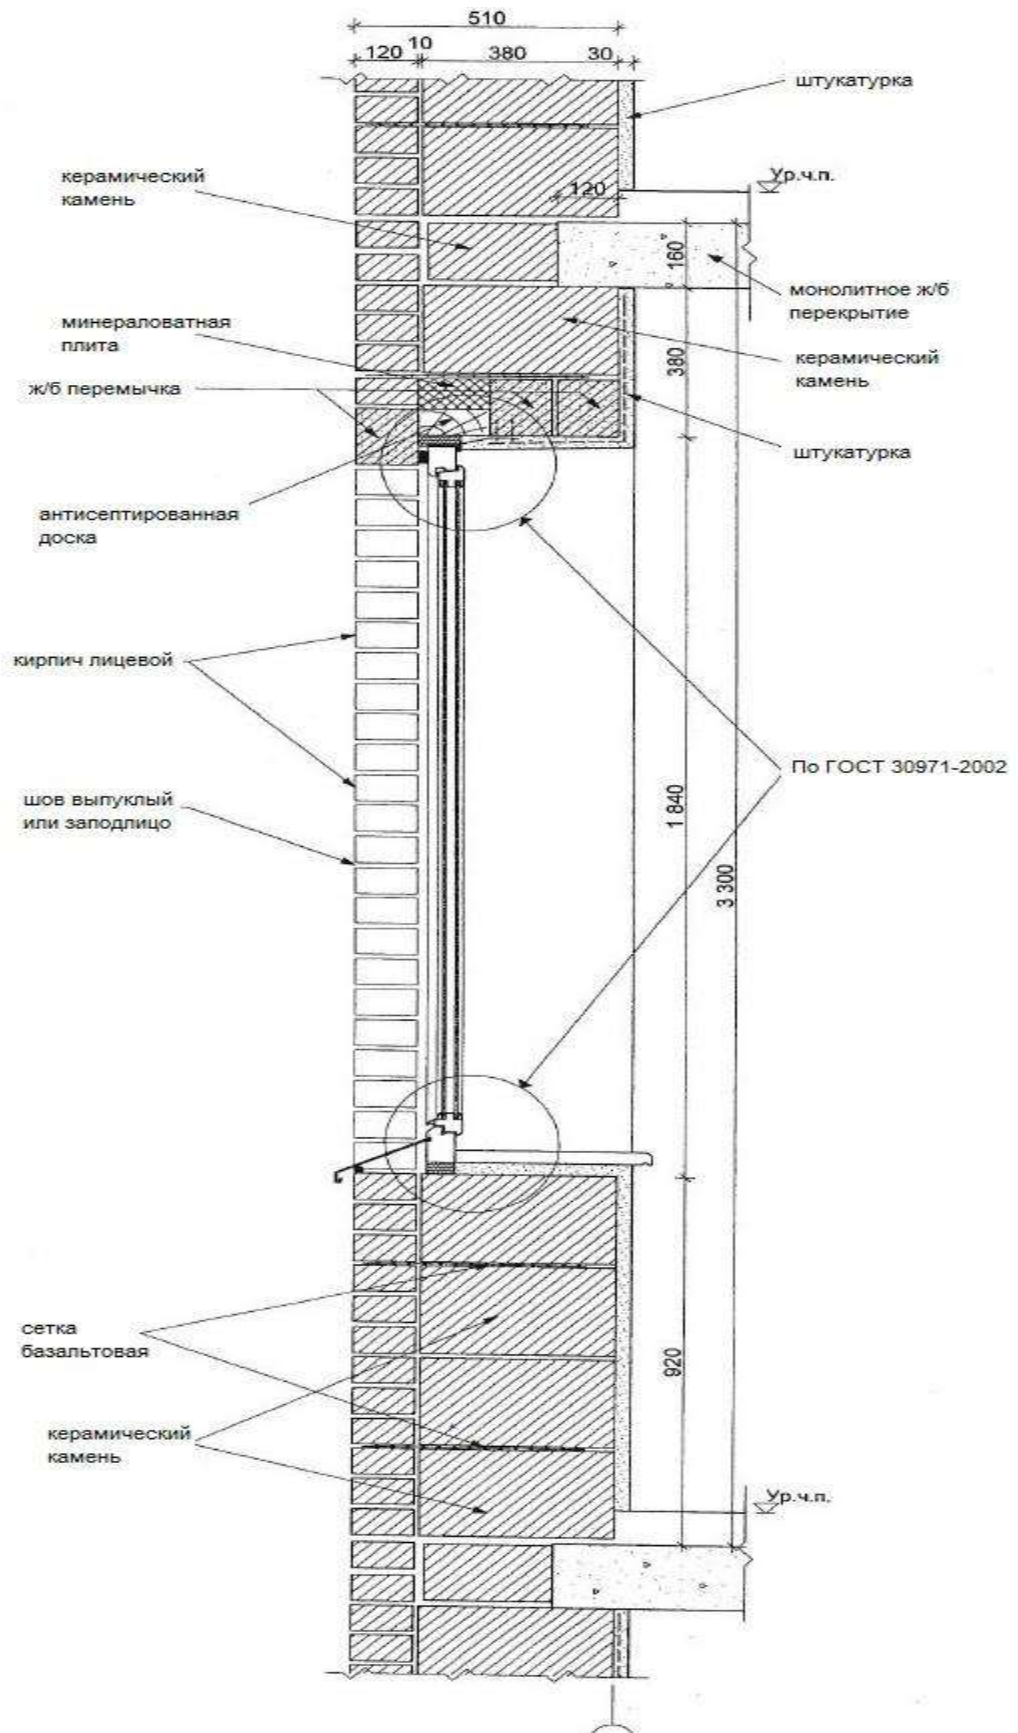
Конструкция двухслойной стены с лицевым слоем из кирпича в зоне оконного проема
